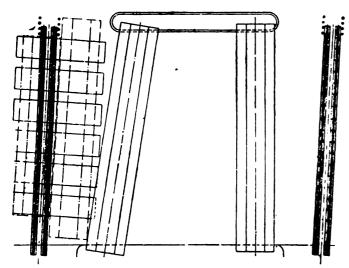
Gru per la sostituzione del ponte - Disposizione planimetrica.
